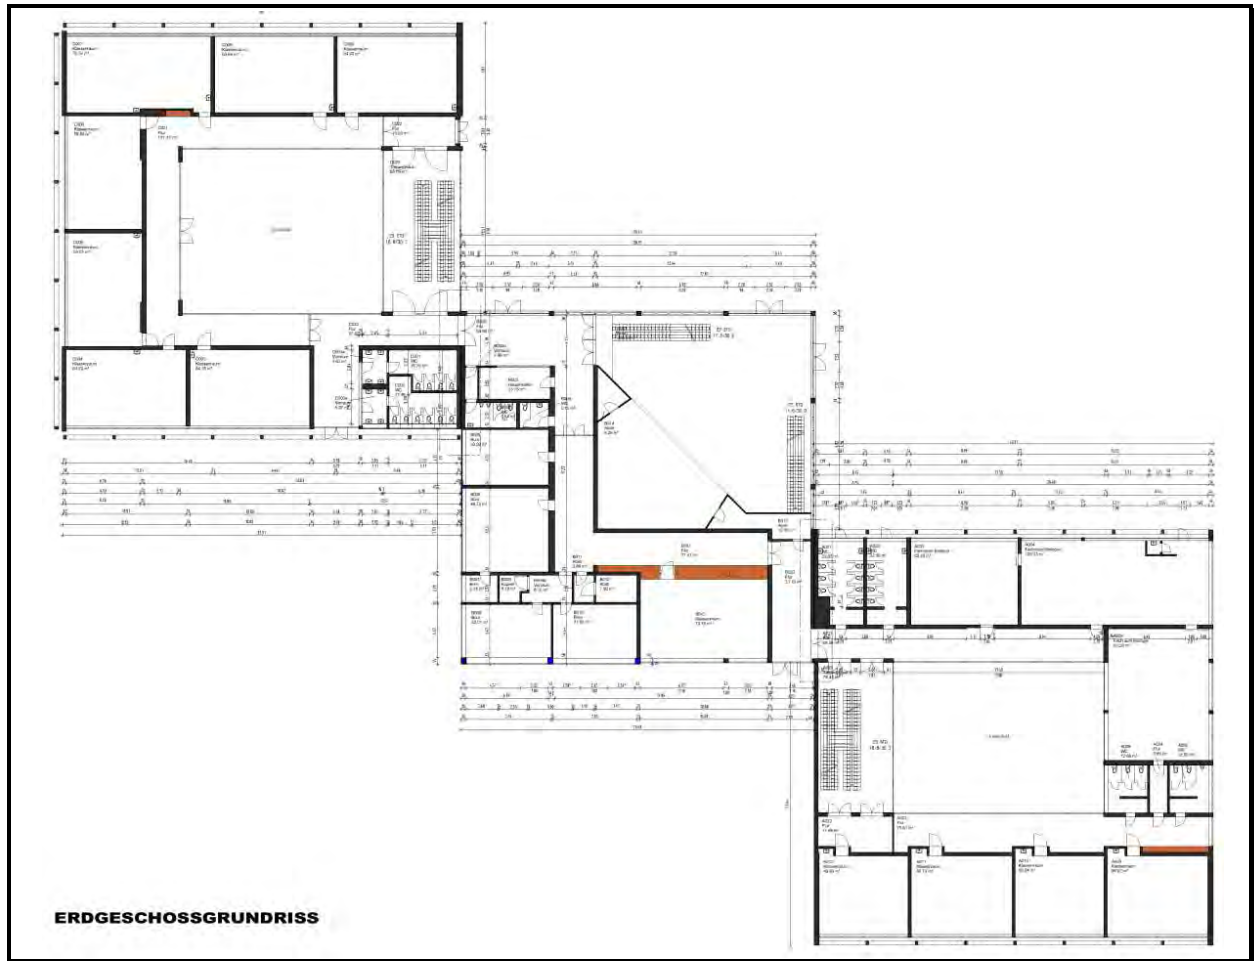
Ernst-Mach-Gymnasium: Grundrisse Bauteile C, B und A
